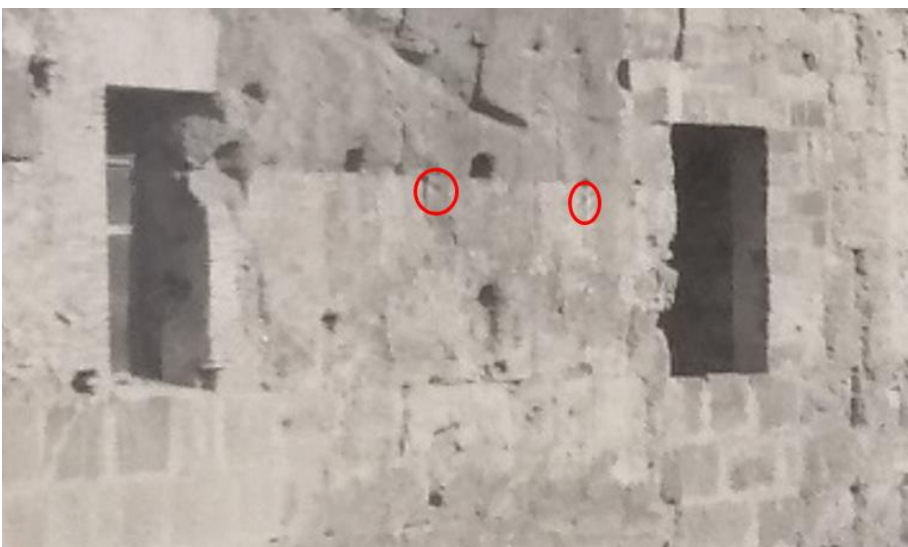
Muro dell'edra nord (foto di archivio del 1928). In evidenza alcune tracce di incavi in corrispondenza e a ridosso dei blocchi di tufo attualmente occupati dall'esemplare di cornice
